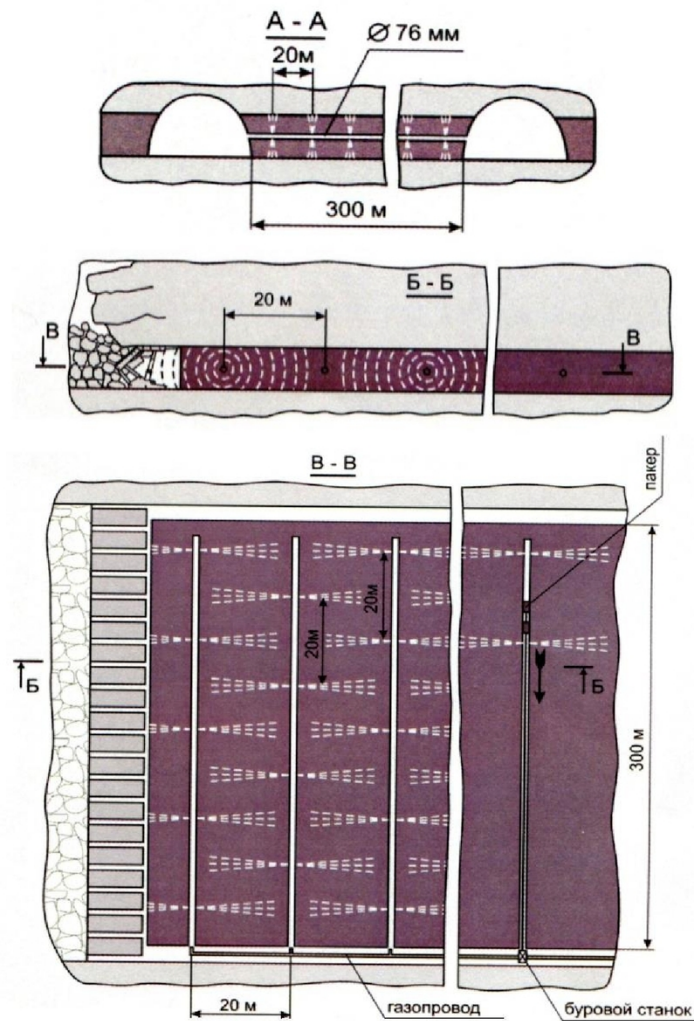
Схема проведения поинтервального гидроразрыва пласта
